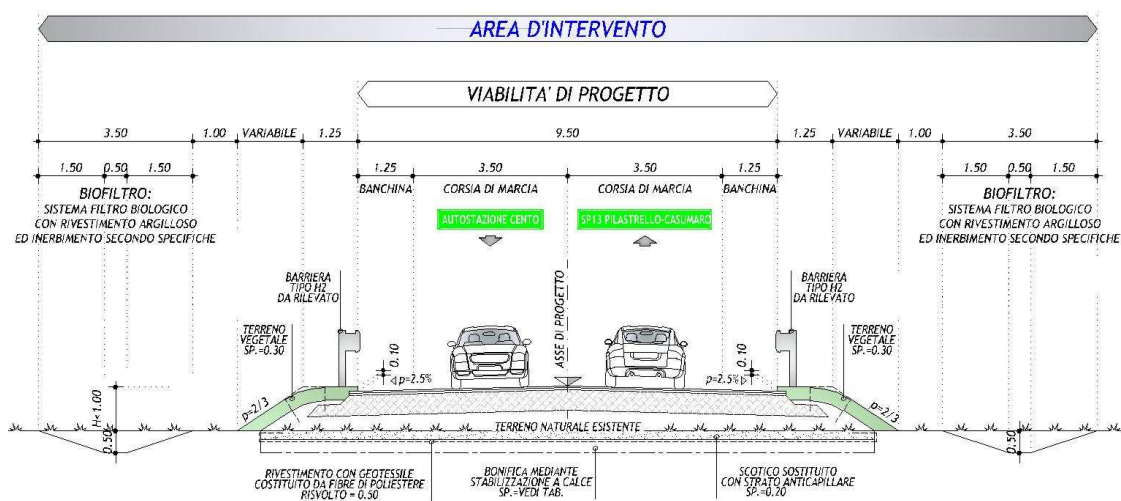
SEZIONE TIPO IN RETTIFILO
